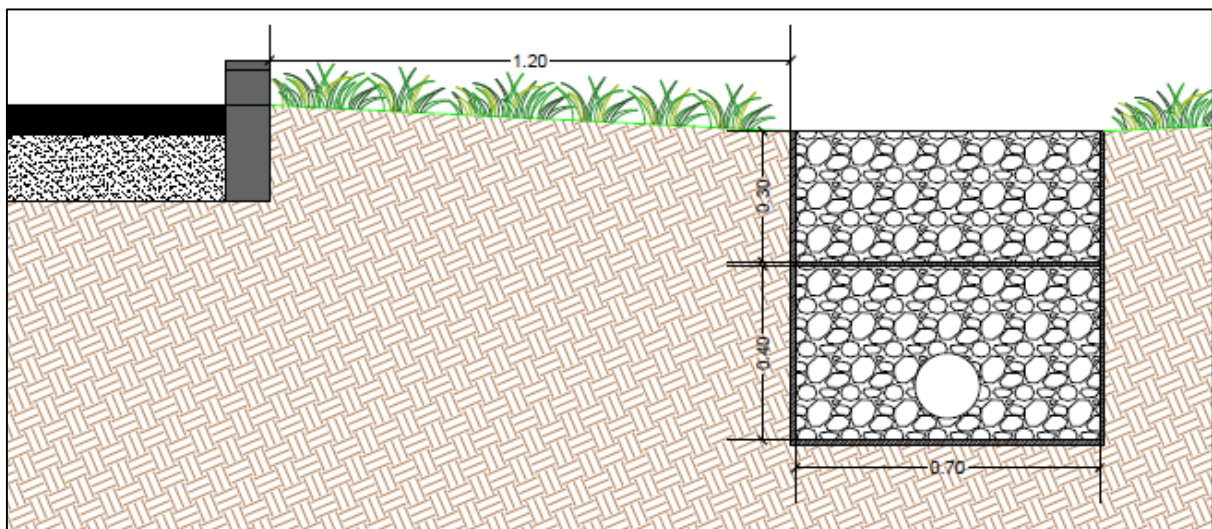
Plano corte sección transversal en la primera zanja filtrante
